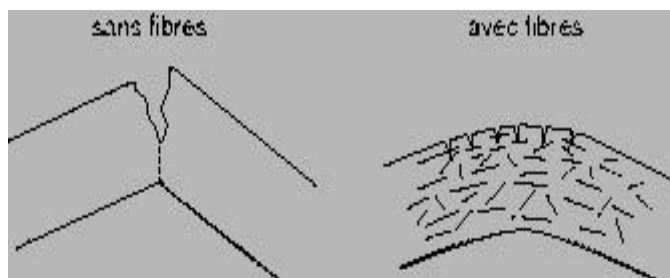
Fissuration dans le béton sans et avec fibres.
